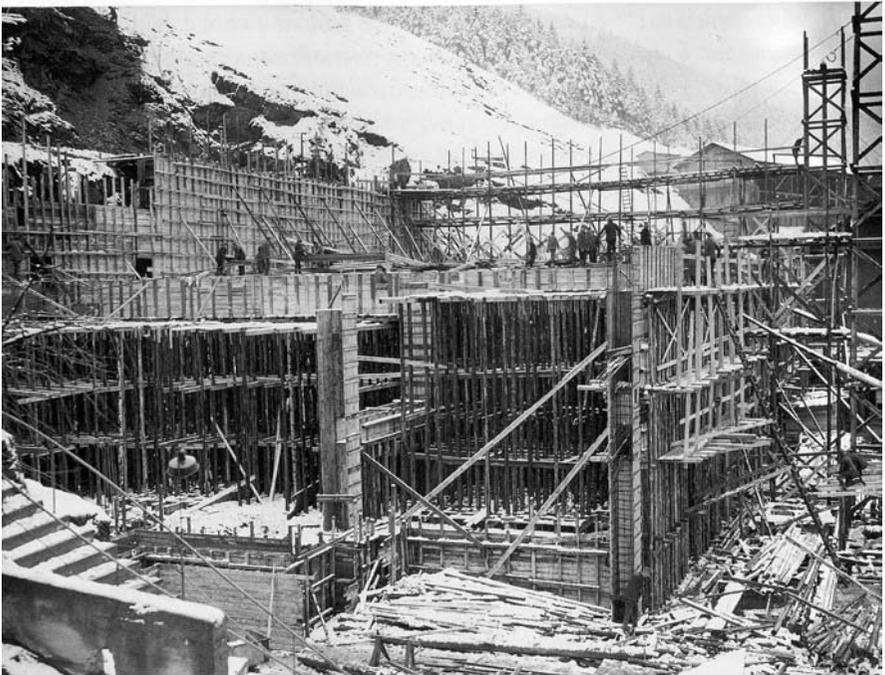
b: Flotationsanlage Rammelsberg im Bau, Rohbau teilweise fertig, Foto aus der Sammlung Heinrich Stöcker
